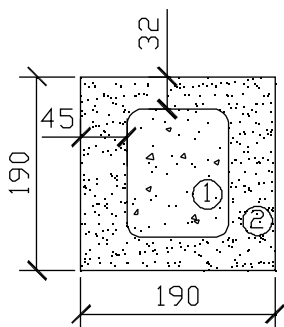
Сечение опытных образцов: 1- бетон заполнения; 2-вибропресованный бетонный камень
